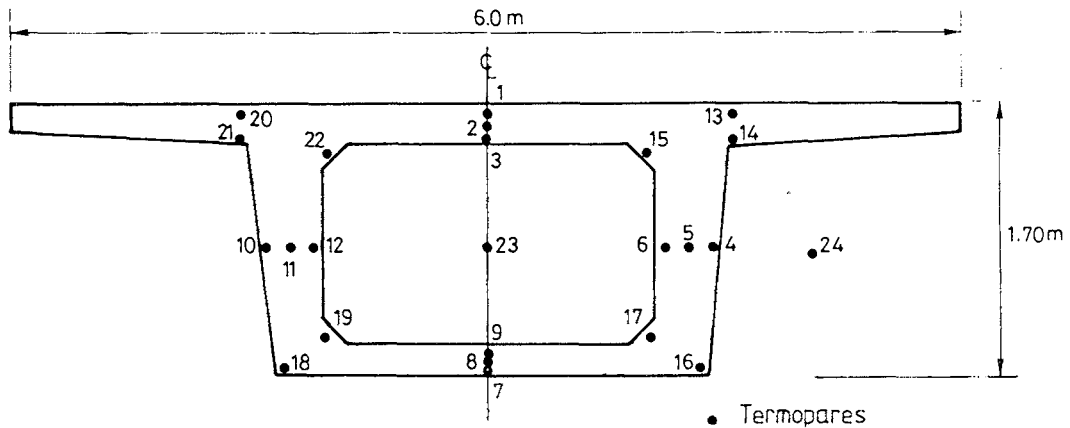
(continuación) Planta del puente instrumentado (dovela 9A).
